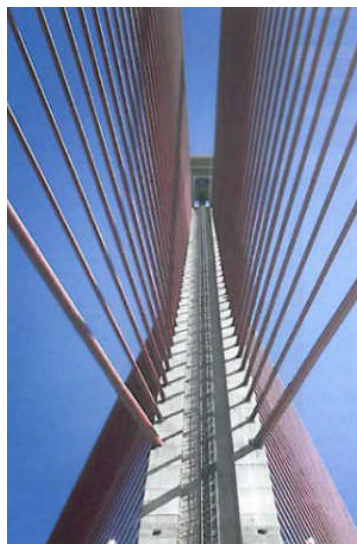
Conexión a pilar Puente Atirantado de Talavera
